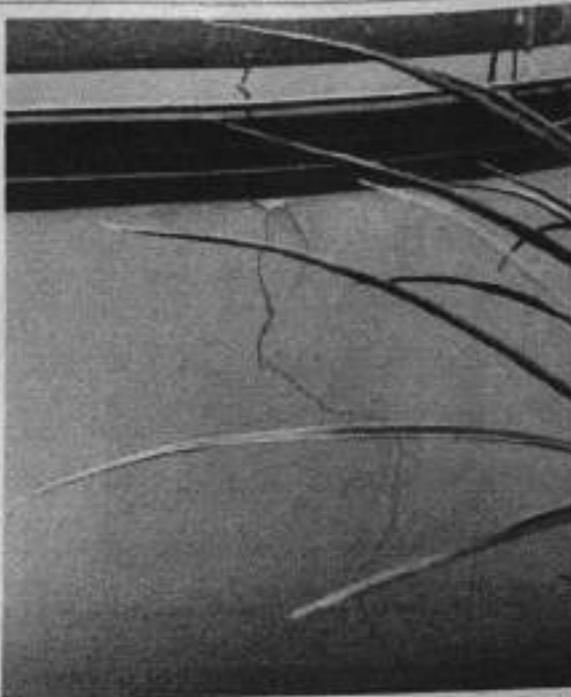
GRIETA TECHO APTO. (2)
